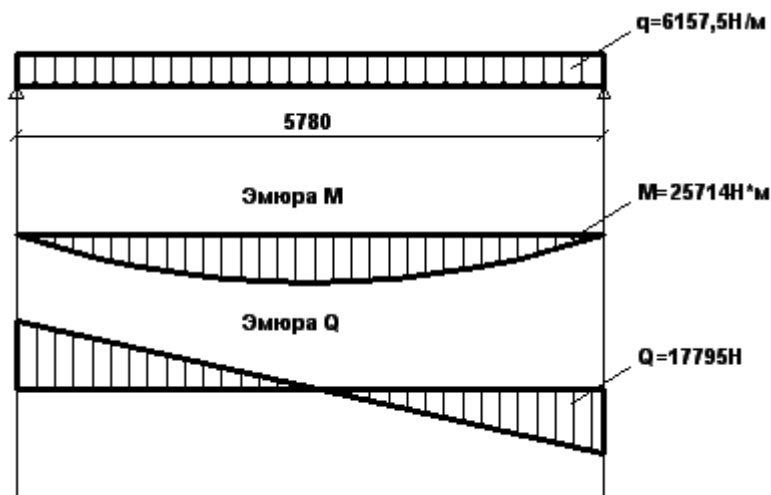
Расчетная схема плиты перекрытия в стадии эксплуатации, эпюра изгибающих моментов и эпюра поперечных сил
